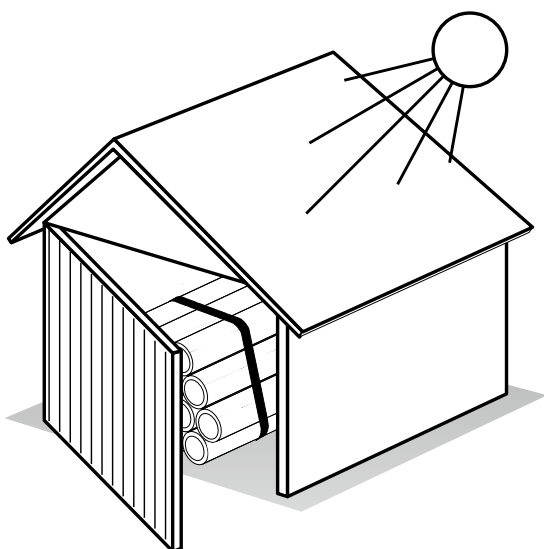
Protezione del tubo dall'impatto diretto dei raggi del sole
